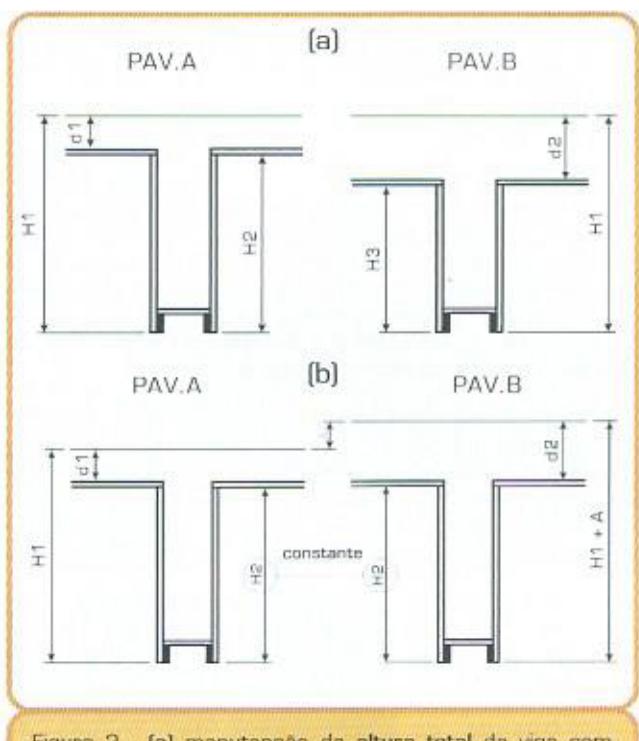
(a) manutenção da altura total da viga com alteração da espessura da laje (entre pavimentos consecutivos); (b) manutenção da altura da viga entre seu fundo e o fundo da laje (entre pavimentos consecutivos) permitindo o reaproveitamento dos painéis laterais e de cimbramento da viga e mantendo inalterado o painel que recebe a viga.
